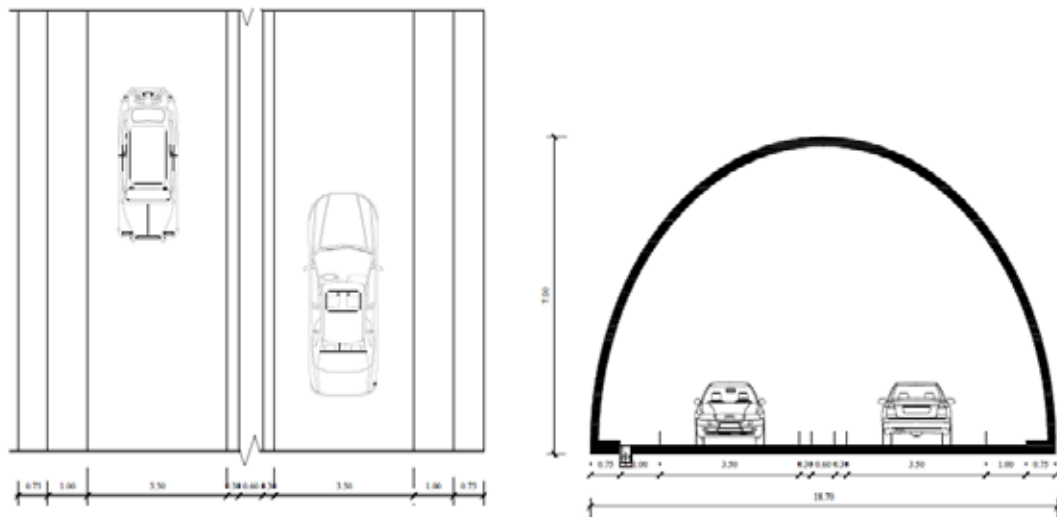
Planta y Sección del túnel Vigirima – Patanemo propuesto
